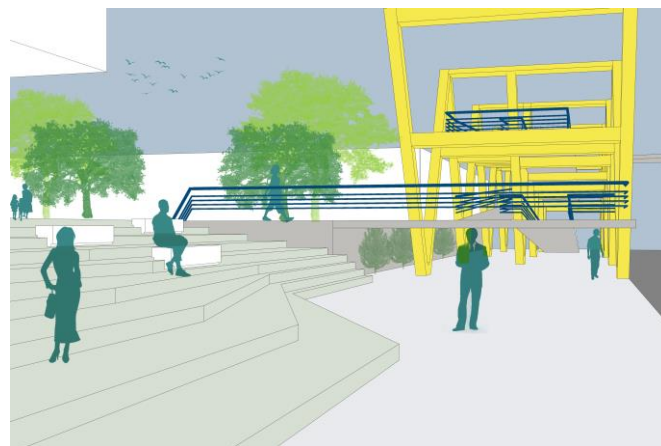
Visão da calçada Av. Djalma Batista. Fonte: acervo da autora, 2021
